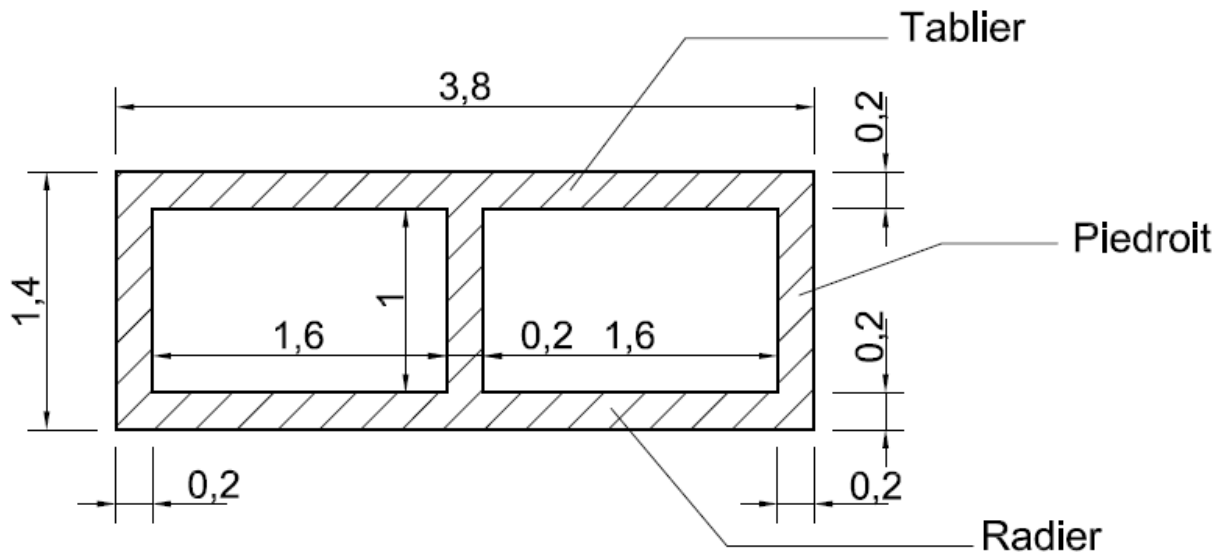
Section transversale du dalot en BA, dimensions en [m]
